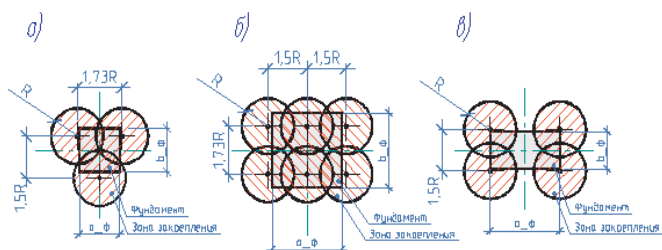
Частичное усиление грунта в плане для столбчатых фундаментов: а, б – закрепление столбчатых фундаментов при равномерном нагружении при разных размерах подошвы фундамента; в – закрепление столбчатых фундаментов при неравномерном нагружении в зонах максимального давления по подошве фундамента
